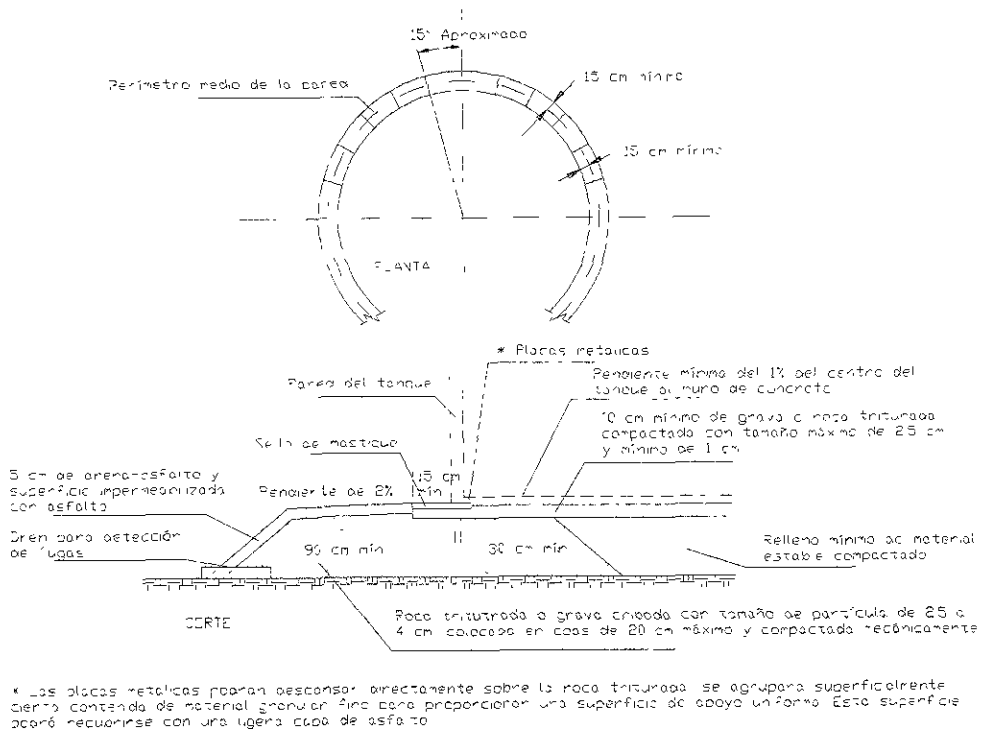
b Cimentación sobre zapata de grava o roca triturada
